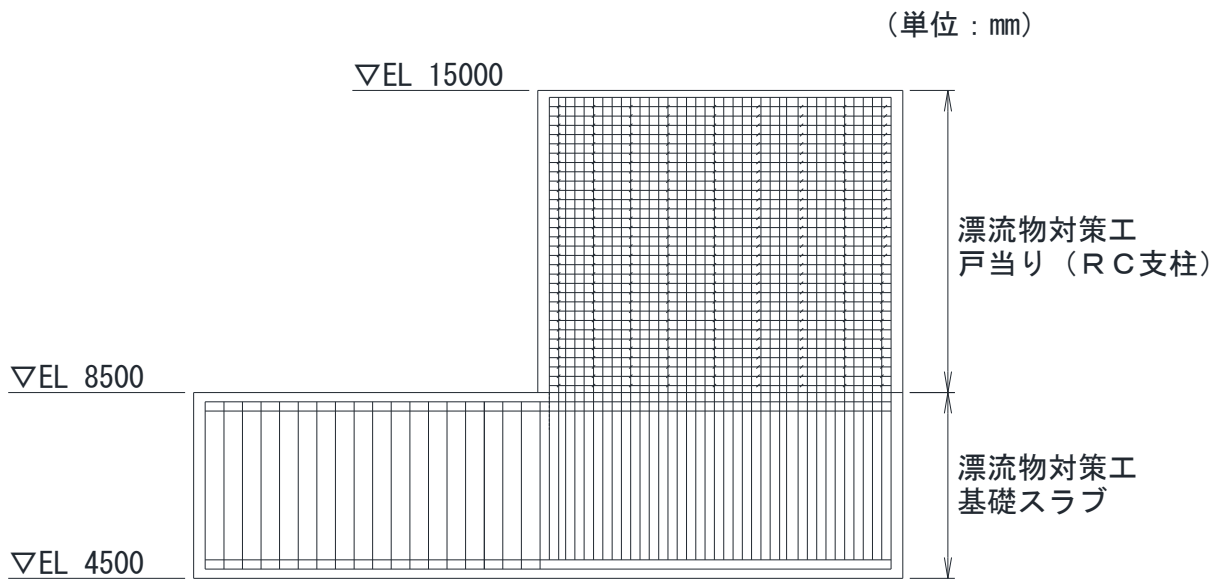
漂流物対策工戸当り (RC支柱) 及び基礎スラブの接続部における概略配筋図 (C-C断面)
